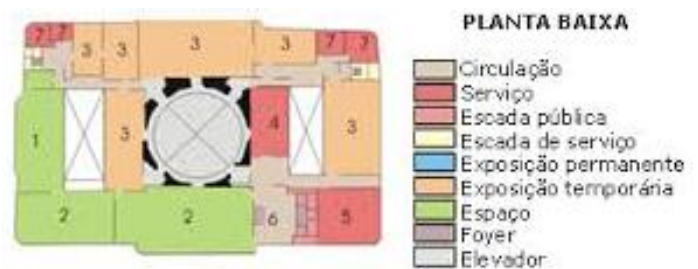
Planta Baixa 1º andar - Centro Cultural Banco do Brasil (1989), Arq. Luiz Telles.
